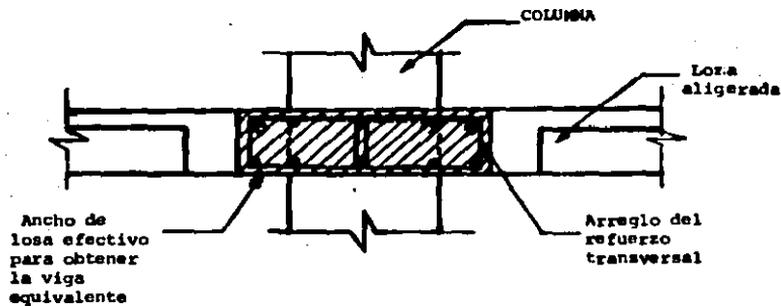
Requisitos de detalle para losas planas aligeradas de concreto reforzado.
